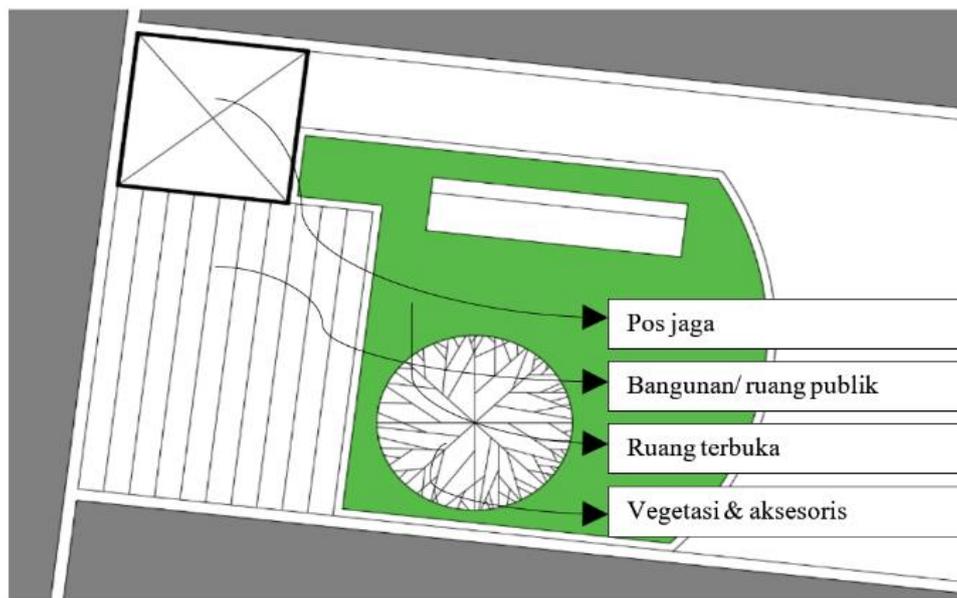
Layout plan pos jaga di Komplek Mandiri.
